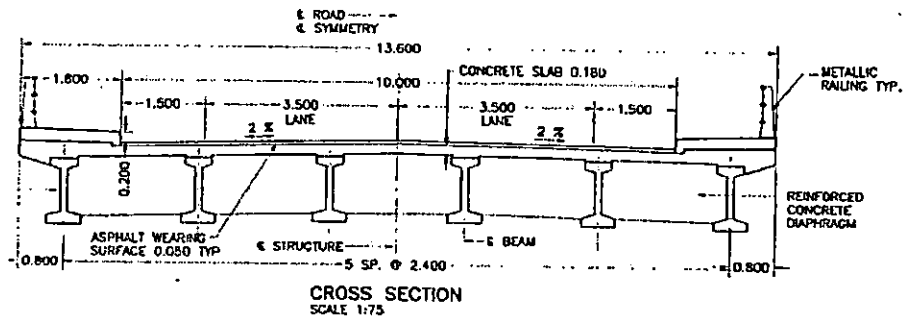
SECCION TRANSVERSAL DEL PUENTE.
